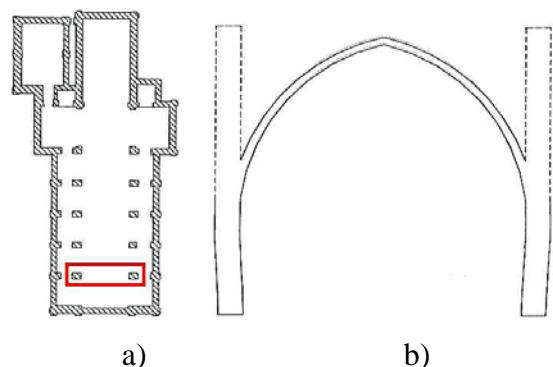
[4k]: a) Planta de marcação do arco deformado
